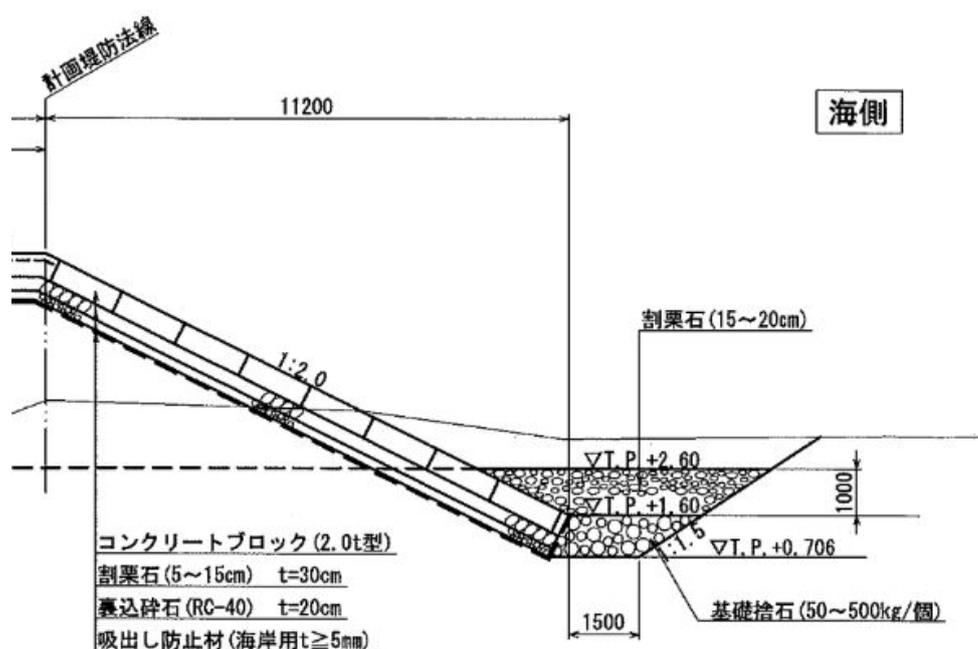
基礎捨石、表法尻保護詳細図
